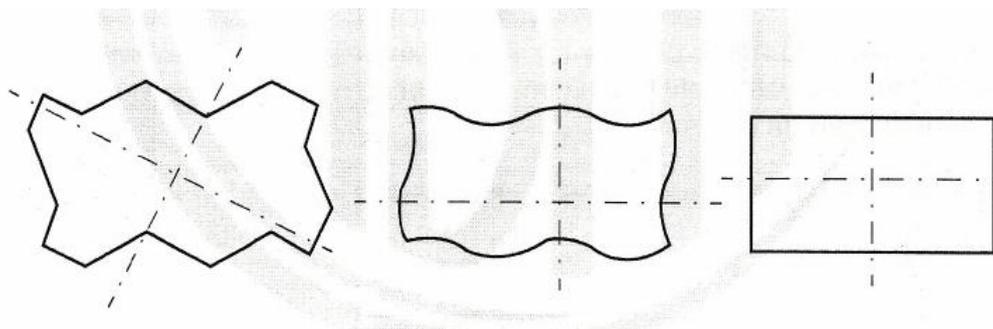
exemplo de peças para pavimentação de concreto do tipo I
